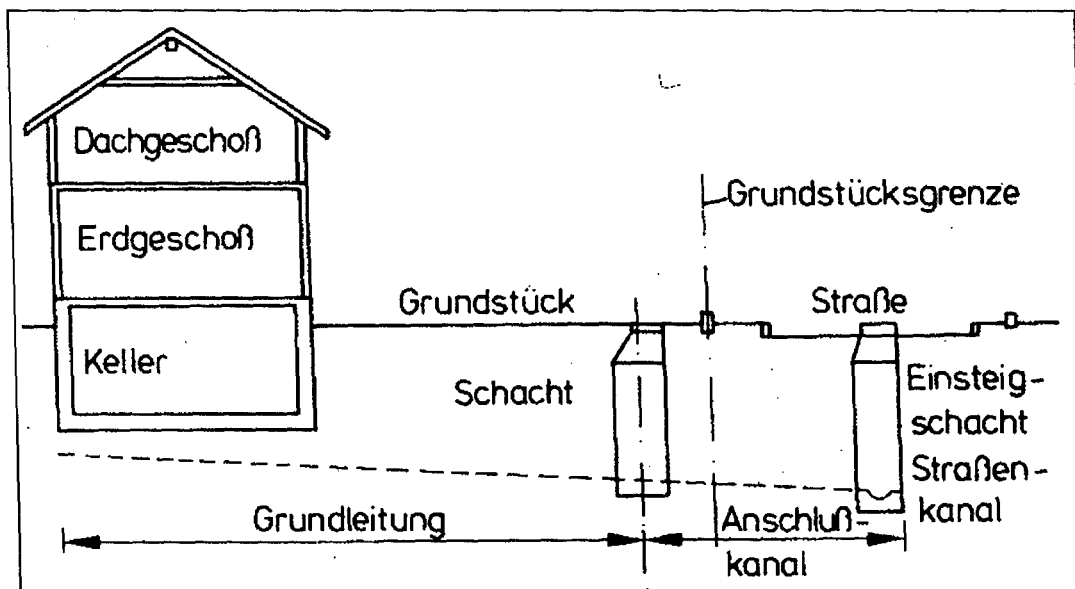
Gebäudeentwässerung über Grundleitung und Anschlusskanal mit Reinigungsöffnung im Gebäude und Einstiegschacht auf dem Grundstück (STEIN, 1999).
